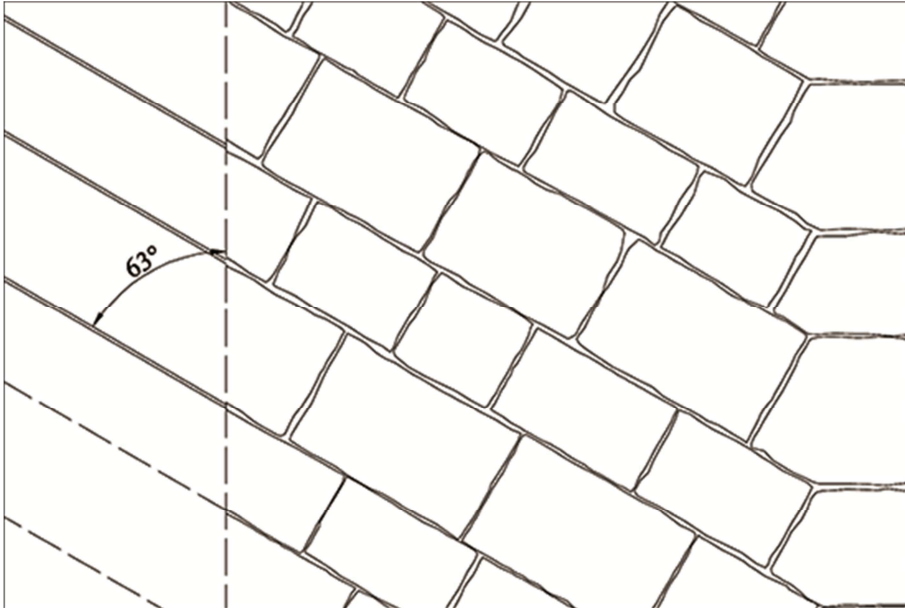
Lastricato con apparecchiatura a file parallele inclinate rispetto all'asse stradale.
